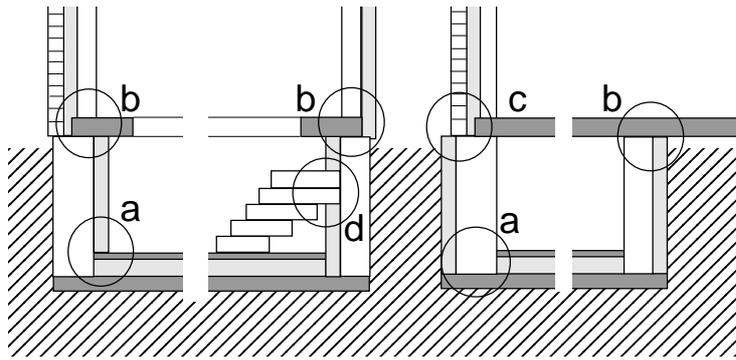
4: Wärmebrücken an Außenwände beheizter Räume gegen Erde.
